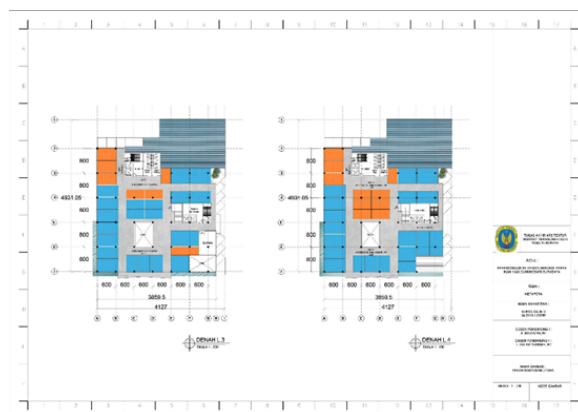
Ruang sesudah re-desain menjadi 5 lantai
